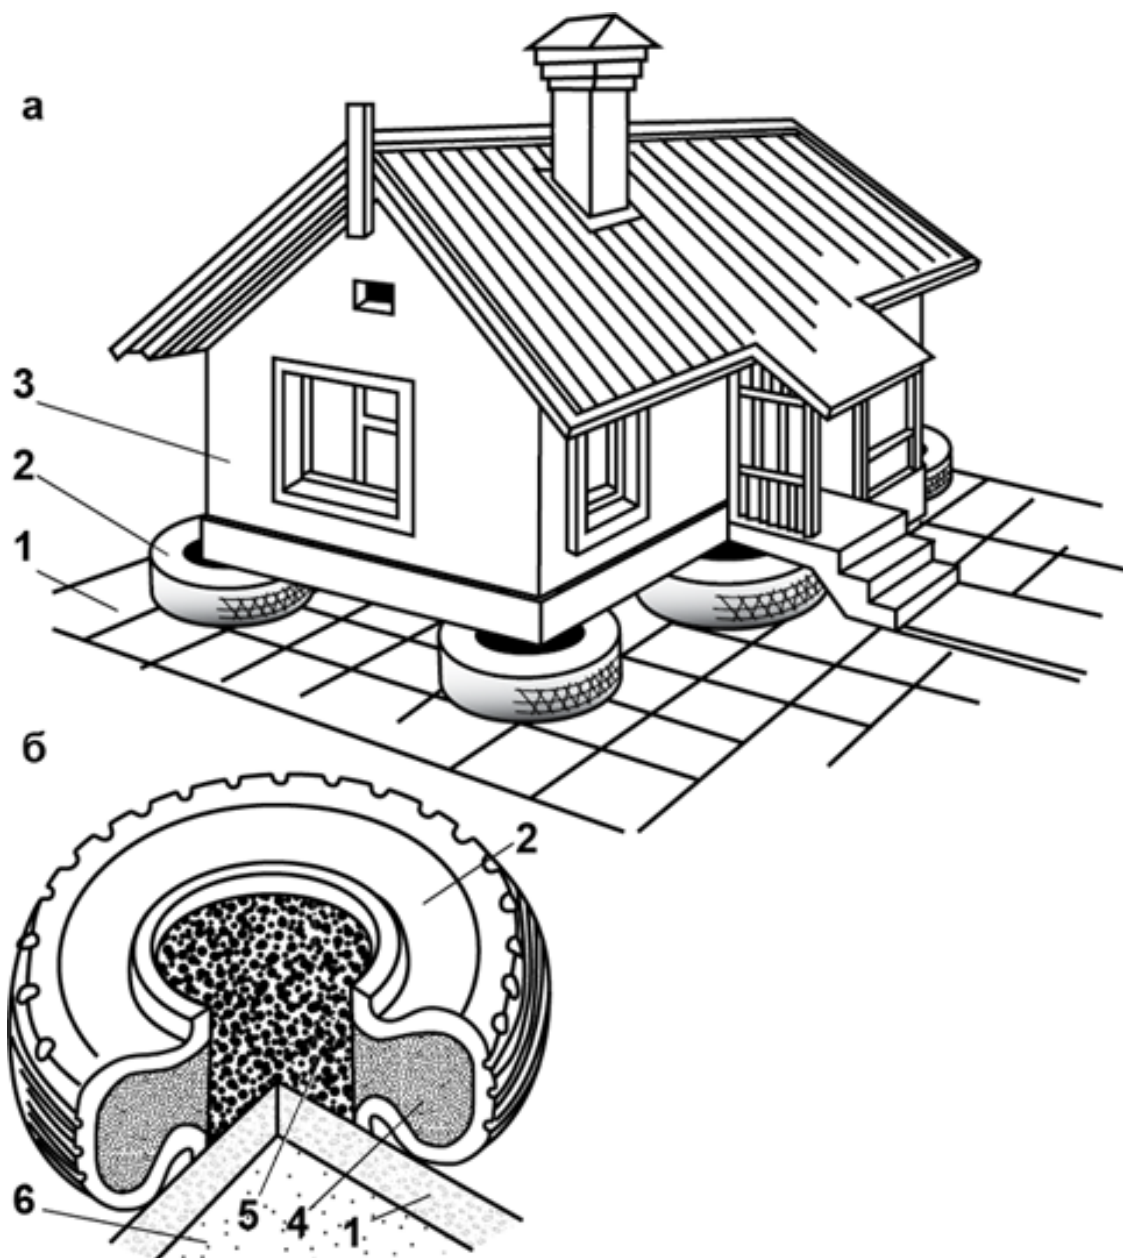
Фундамент из автопокрышек: *а* – общий вид дома; *б* – конструкция фундамента; 1 – бетонная плита основания; 2 – автопокрышка; 3 – жилой дом; 4 – песок; 5 – гравий; 6 – утрамбованный грунт основания
